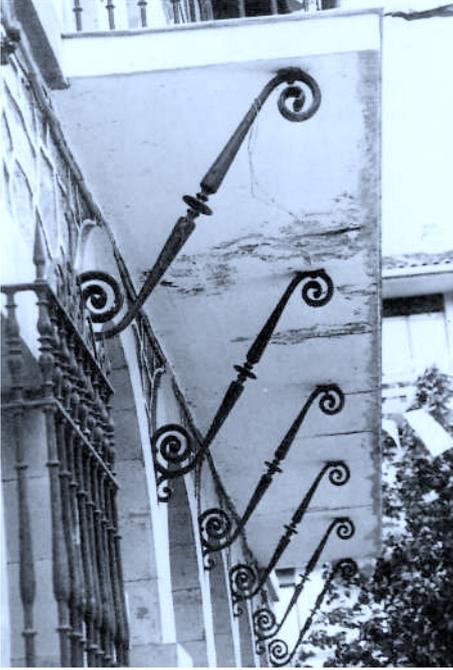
Ayto. de Carranza proyectado por el arquitecto Rafael Fontán en 1938. Detalle del soporte del balcón de la fachada principal.
